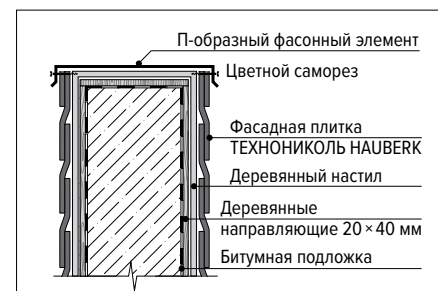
Монтаж фасадной плитки на подпорную стенку. Вариант 2
